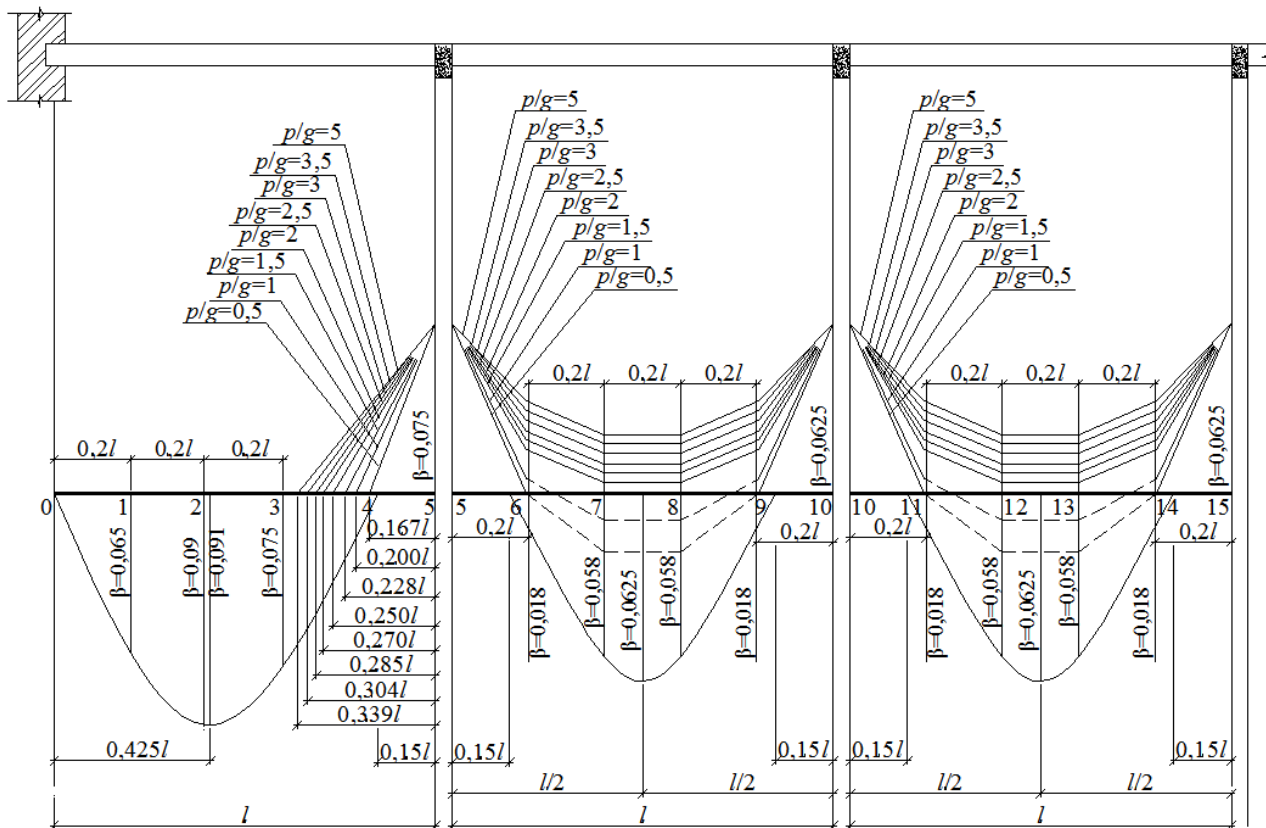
Эпиюры расчетных моментов для равнопролетных неразрезных второстепенных балок
